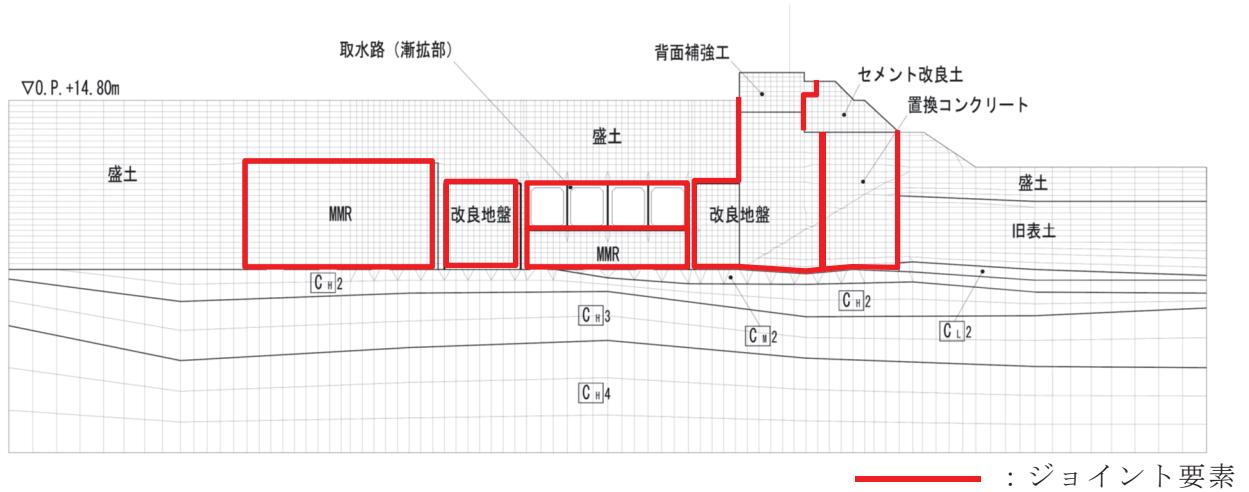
ジョイント要素の配置図（取水路（漸拡部）の例）
